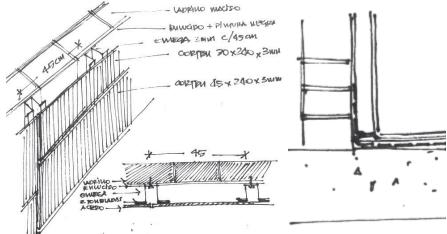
Materialidad y sistema constructivo en Fachadas Casa RVR
